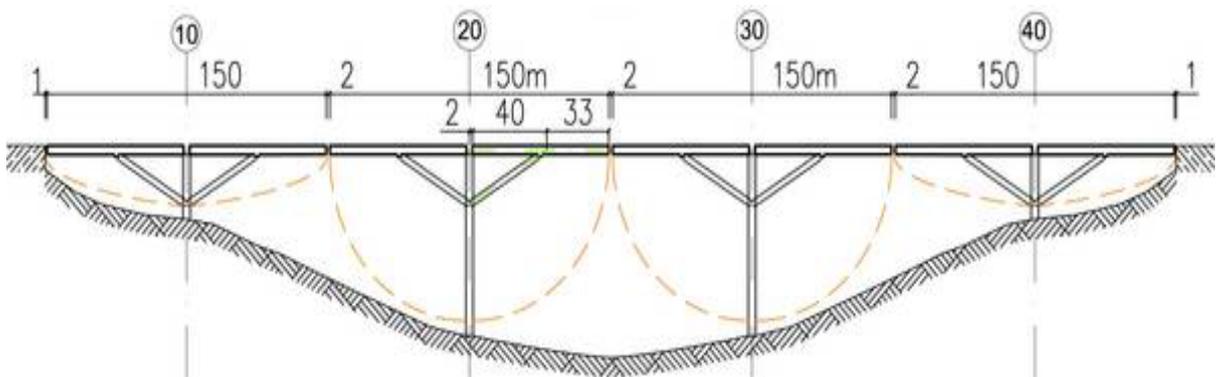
Darstellung der Klappradien bei der Druckstrebenvariante
